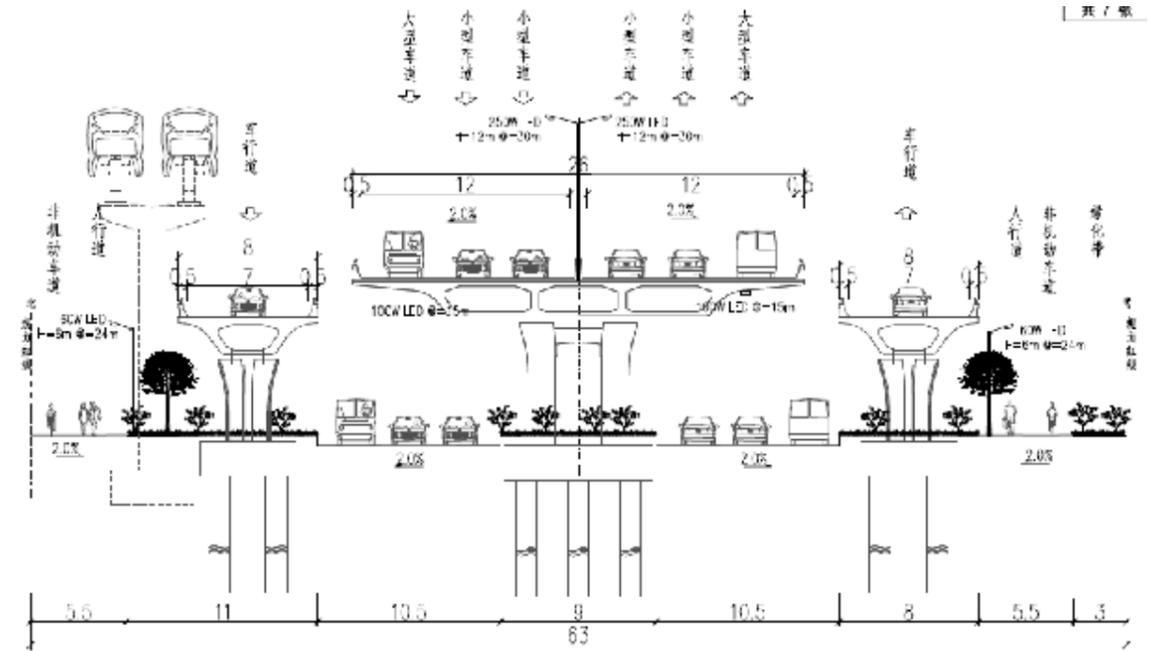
金沙西路西延（K5+010-K5+480）照明横断面图（尺寸单位：m）
